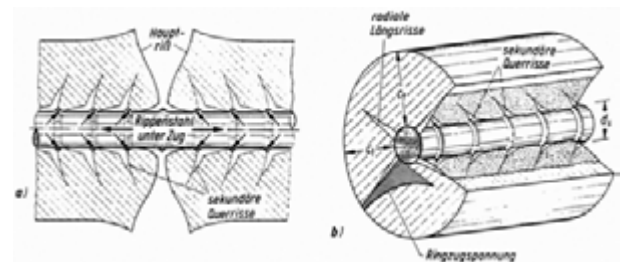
Sekundär-, Haupt- und Längsrisse an einem Stahlbetonstab unter zentrischem Zug aus [Müller et al.-83]
